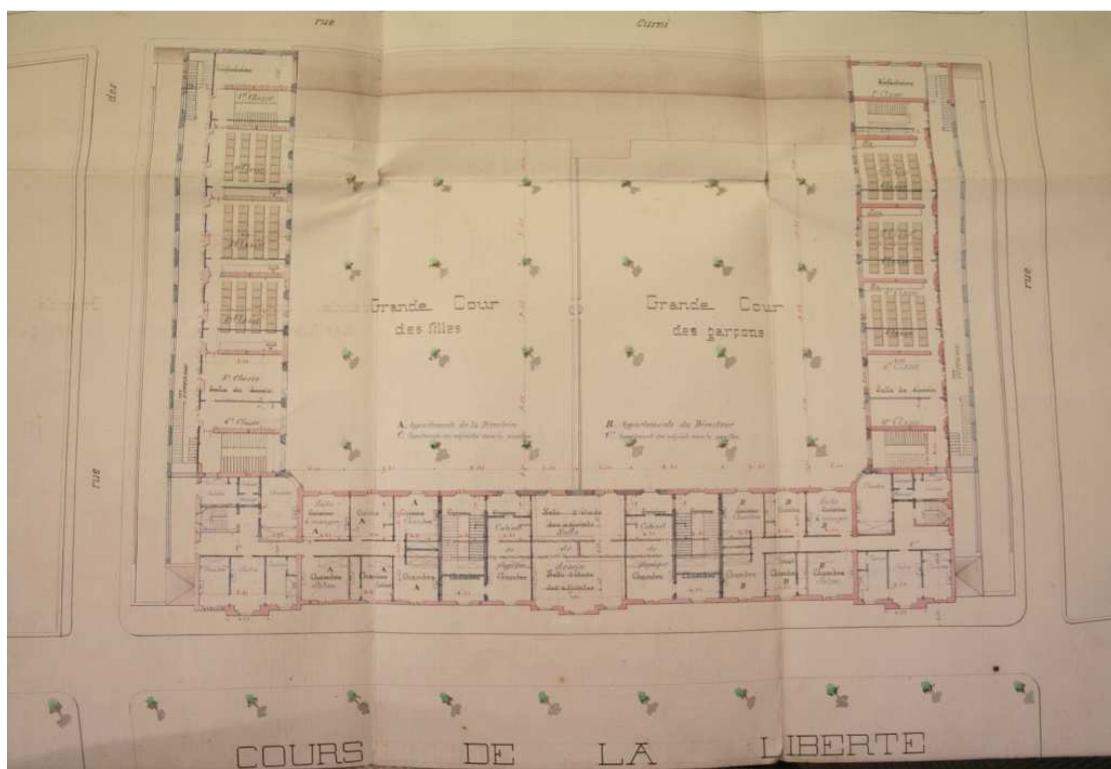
Projet de Groupe scolaire. Plan du rez-de-chaussée.
